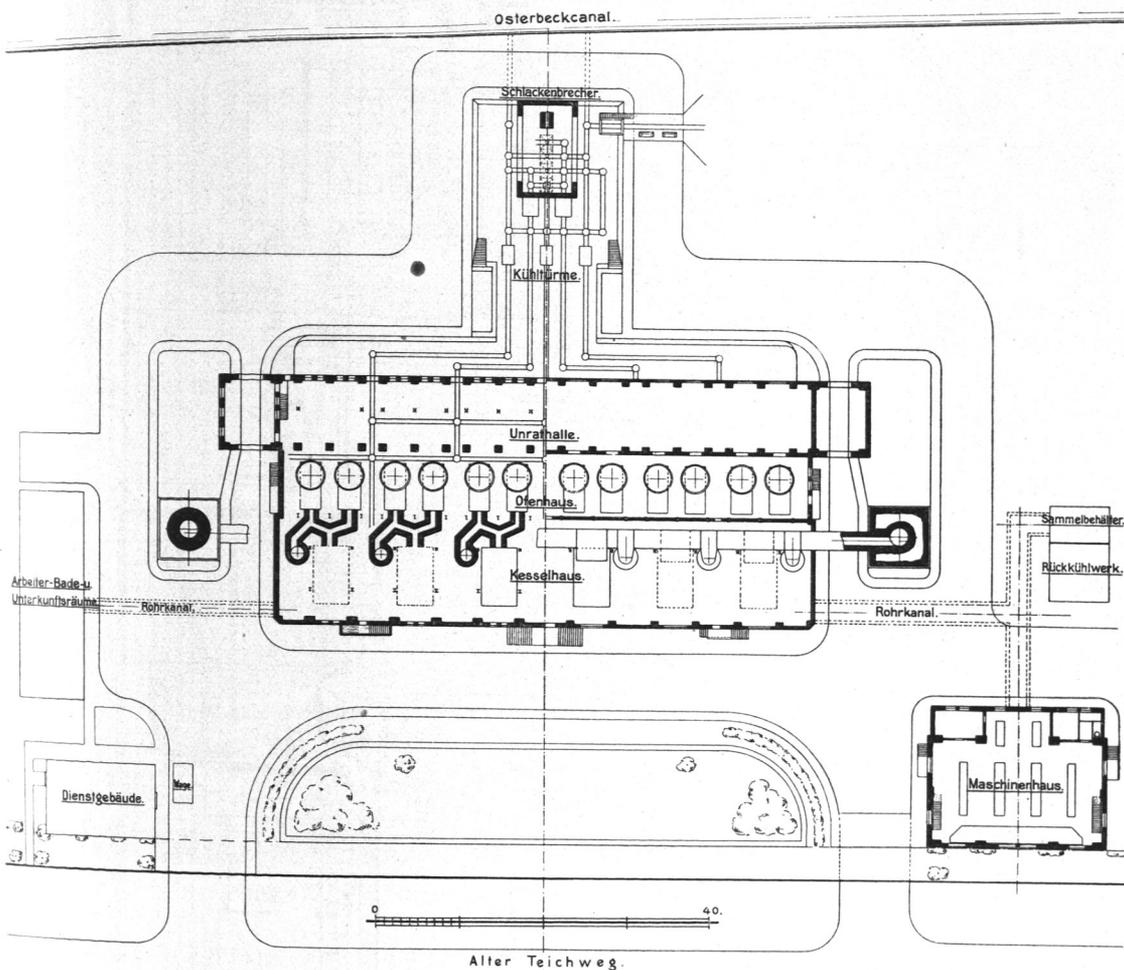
Verbrennungsanstalt am Altter Teichweg, Lageplan.
